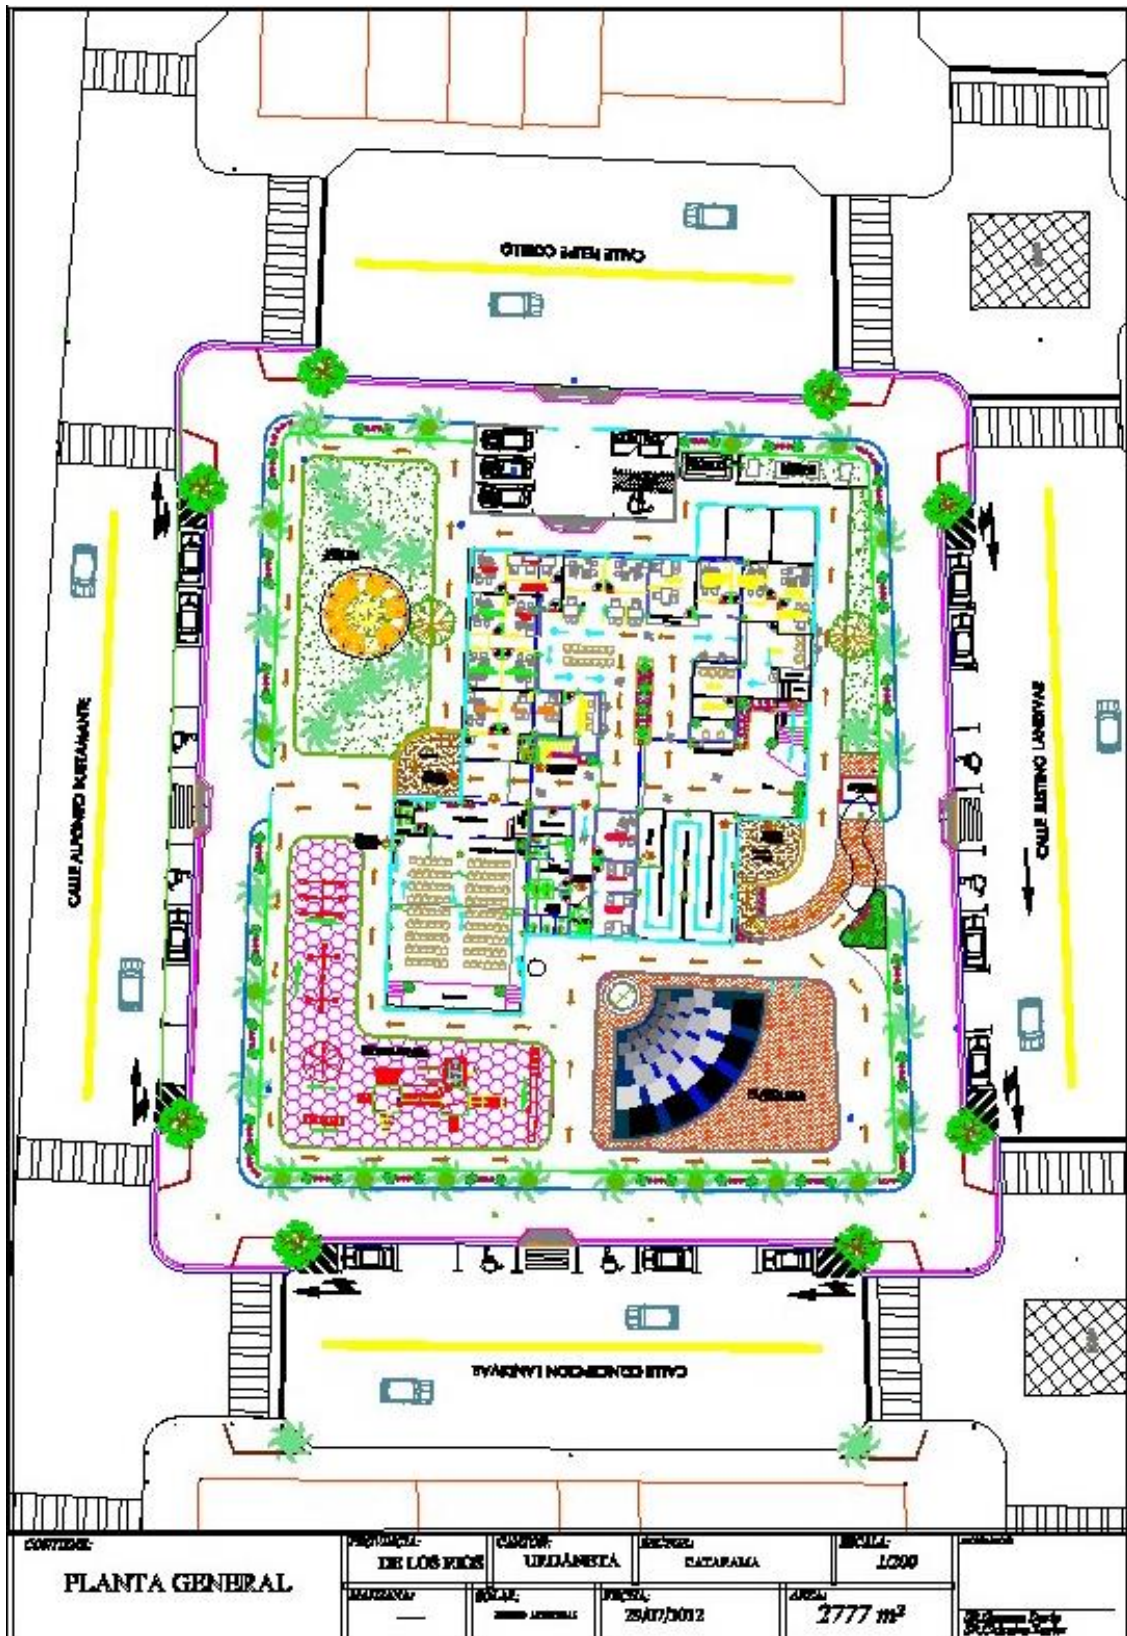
Plano de implantación general. Fuente: Elaboración propia del autor
